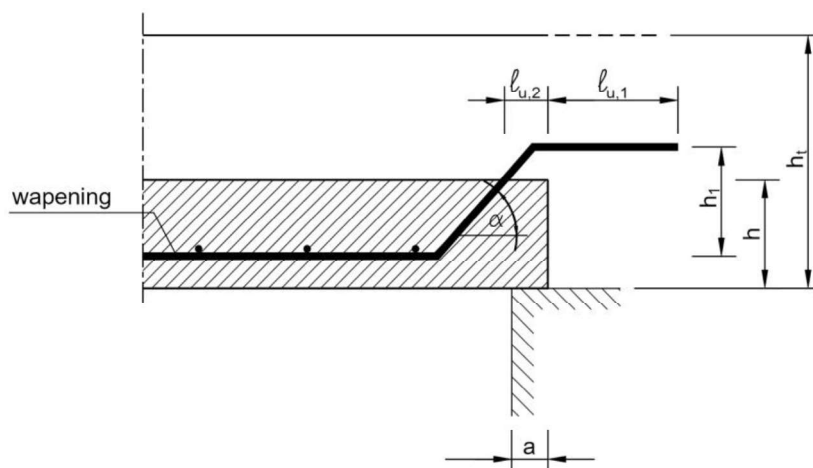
c-bis - Verankering van de wapening met opgebogen uitstekende wapening ter plaatse van een oplegging
